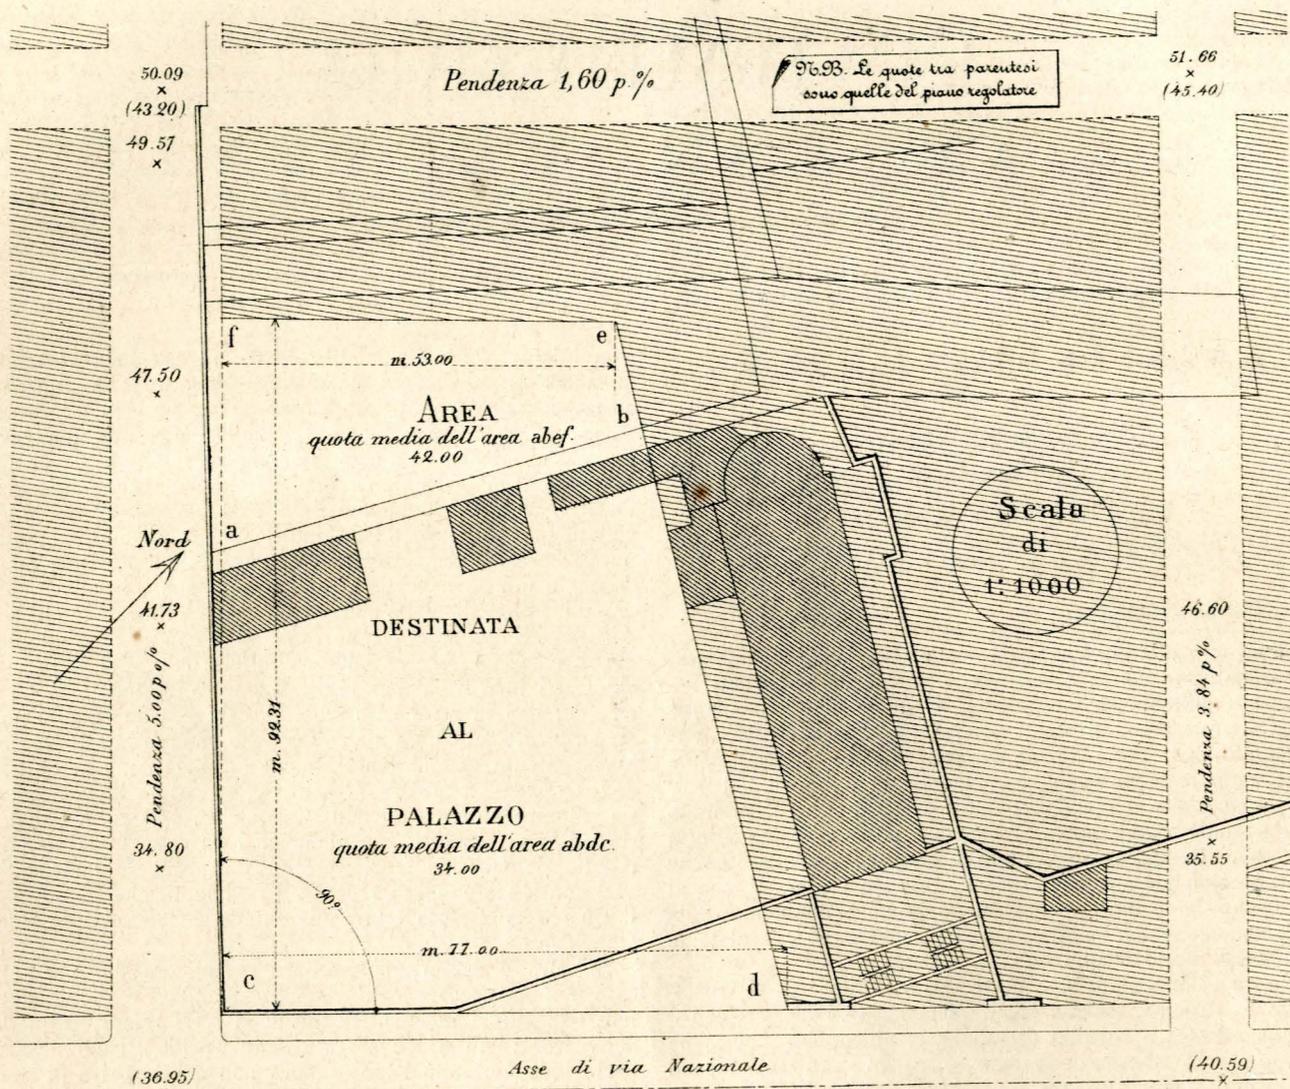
PLANIMETRIA DELLA LOCALITÀ
